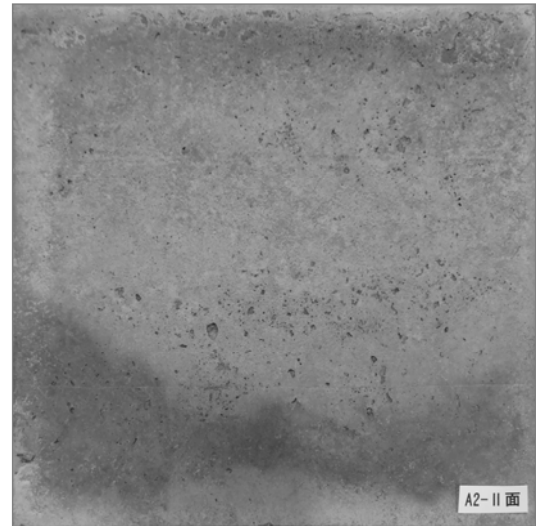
表面気泡の状況 (試験体 A, 不織布面)
